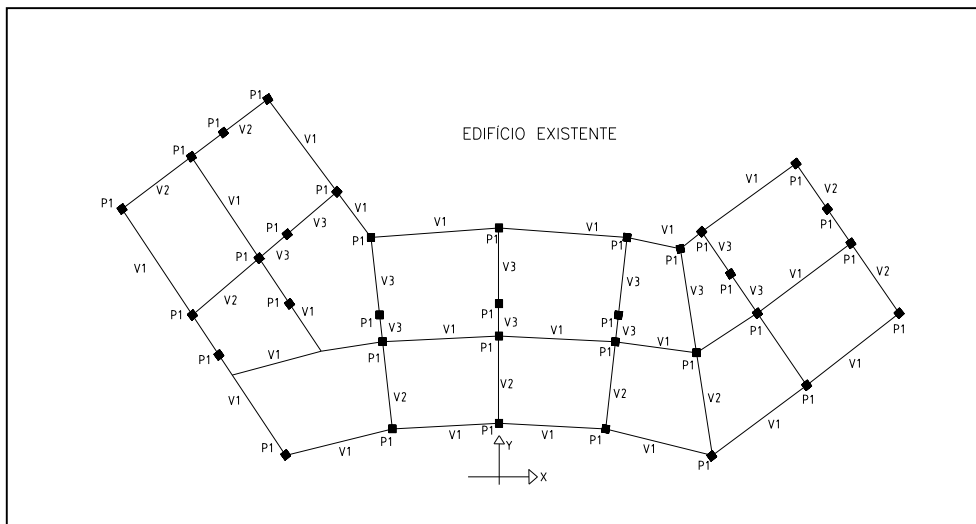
Planta estrutural do edifício utilizado como exemplo.
